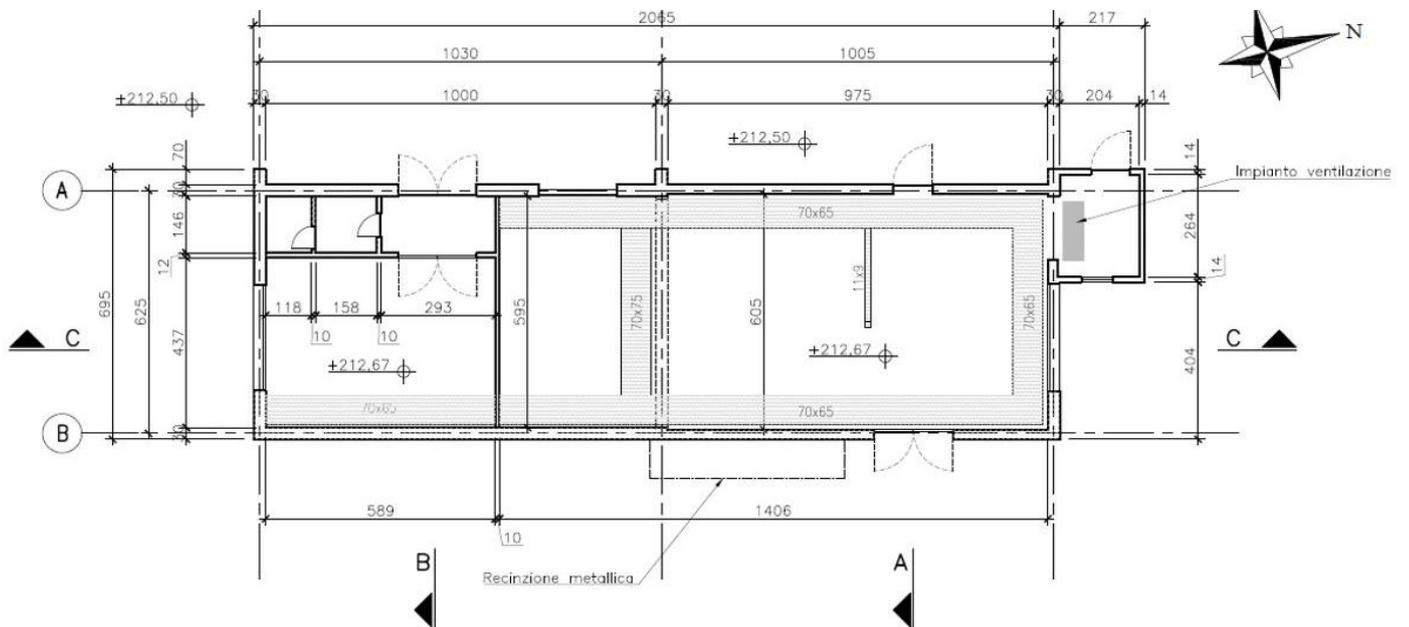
Pianta dell'edificio 21h - Ante Operam
